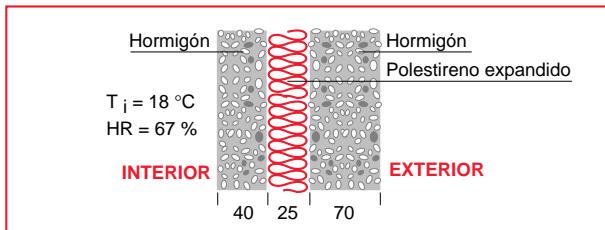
Muro de sistema pesado de grandes paneles de hormigón
